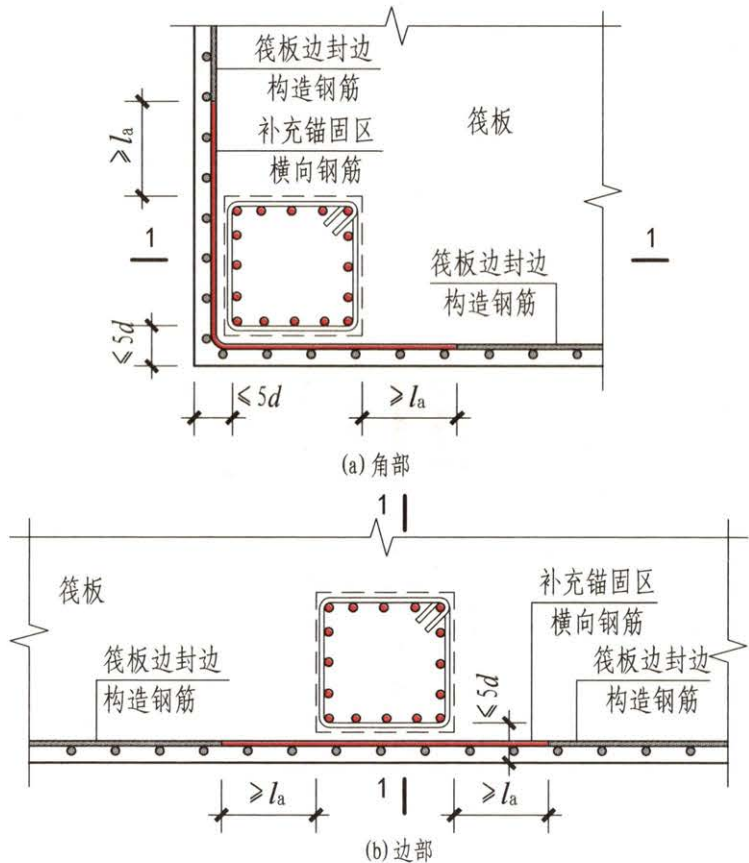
柱插筋锚固区横向钢筋的排布构造(一)
